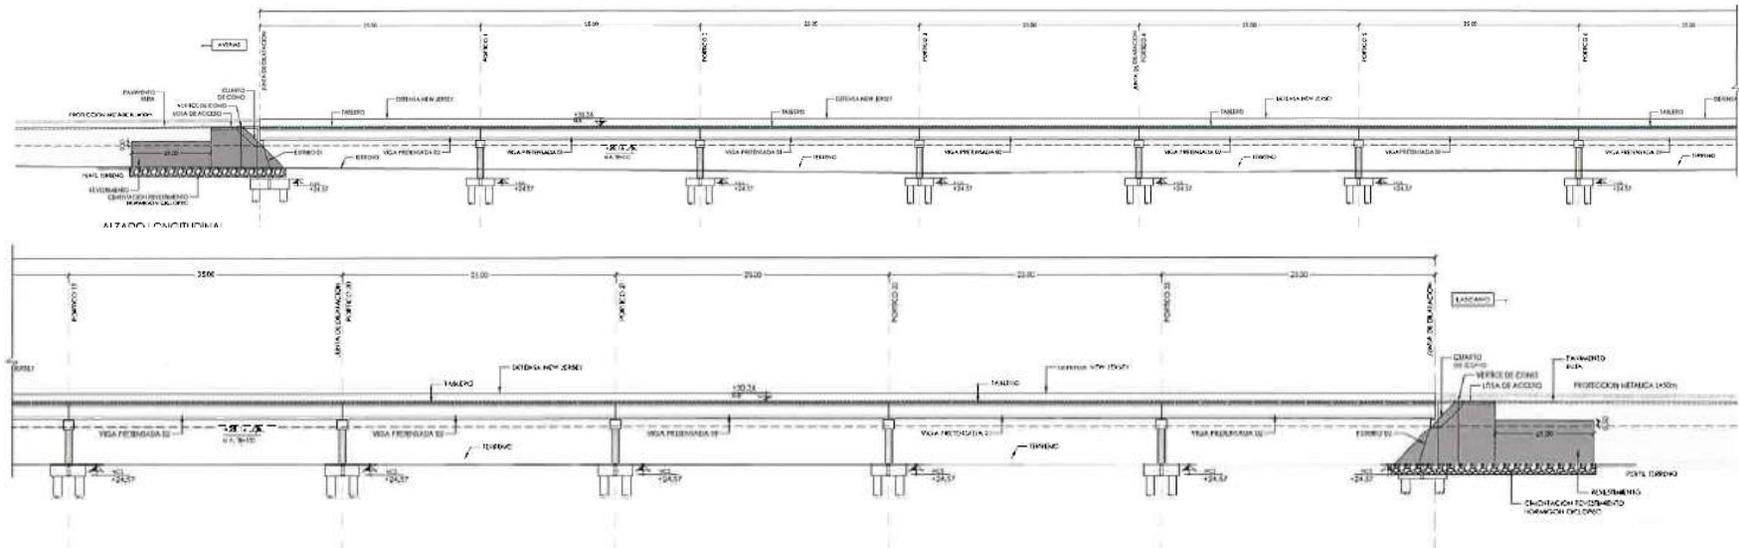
Extracto de plano de puente sobre la planicie de inundación del río Cebollatí
